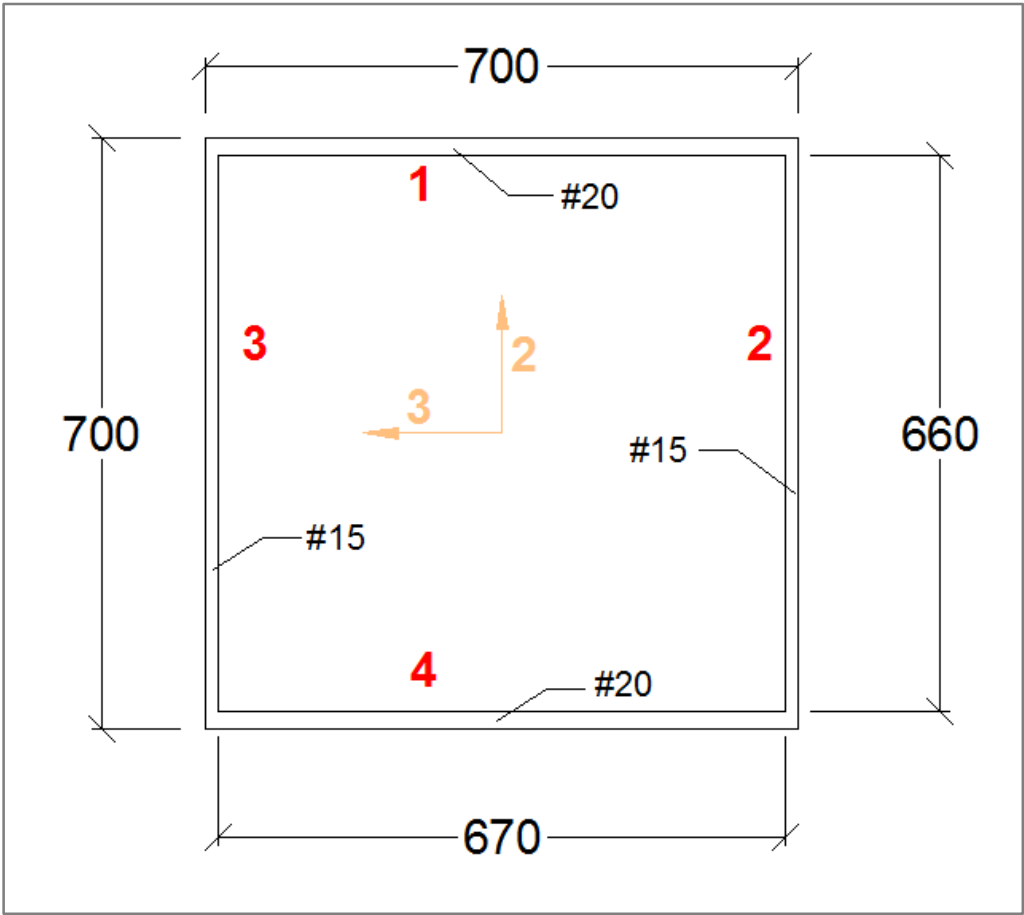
Dimensiones cajón vigas longitudinales de pasarela (Cotas en mm)
